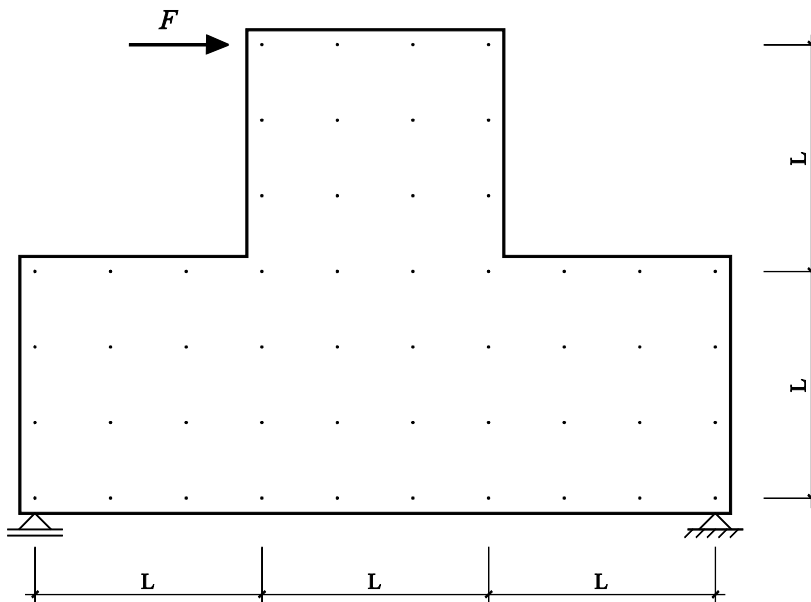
Stahlbetonscheibe mit Kraft F .
